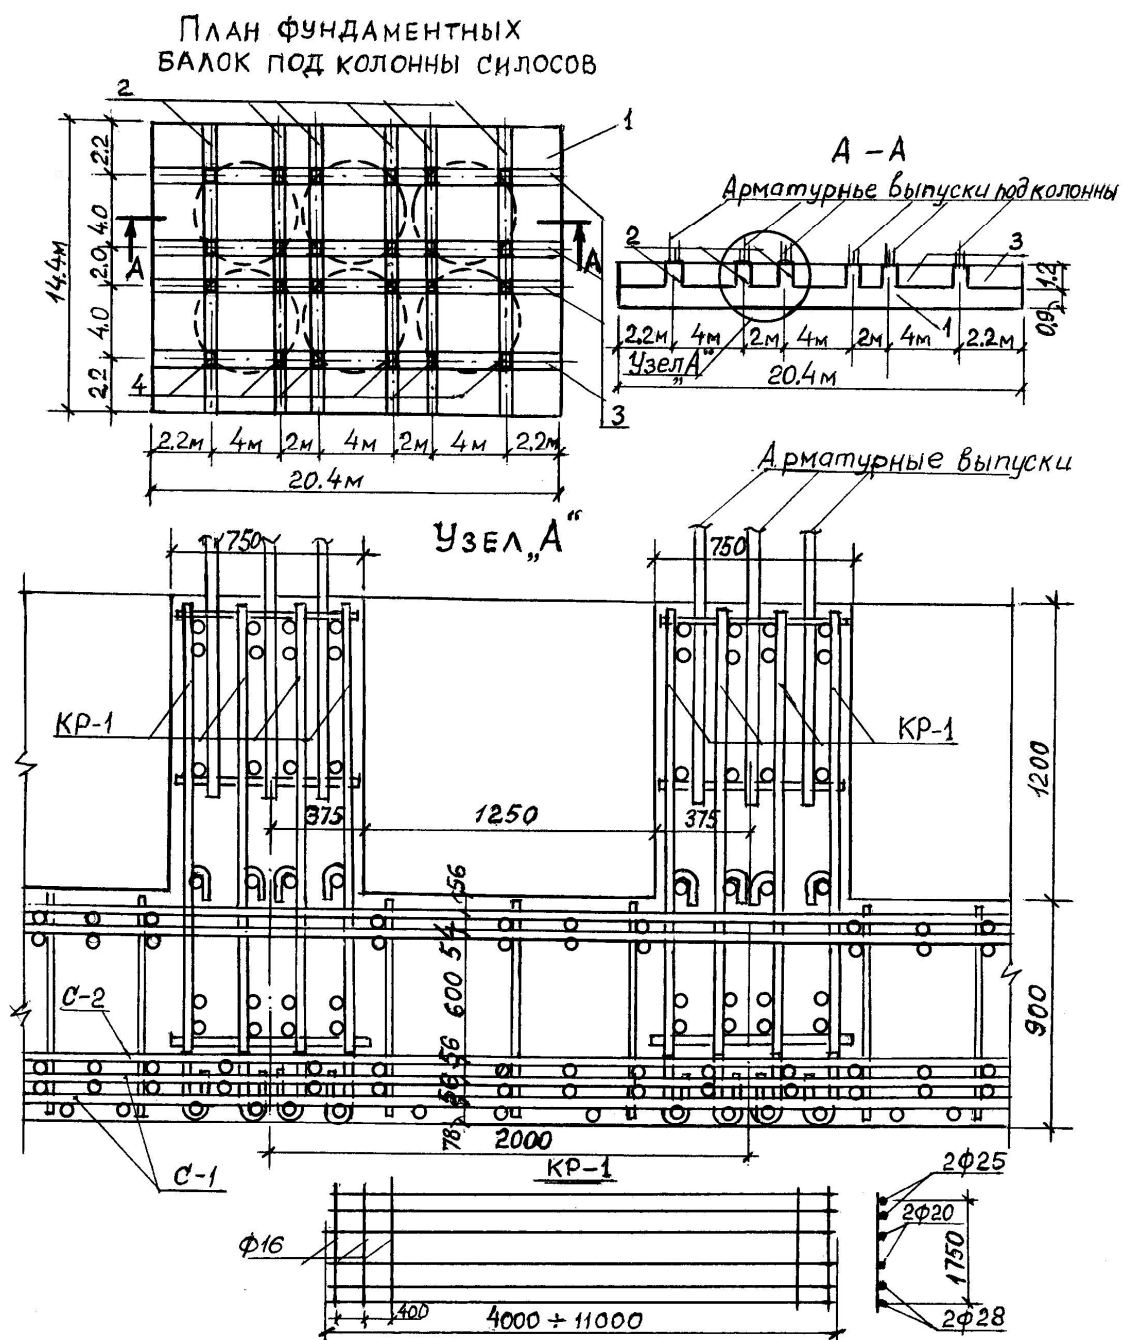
Вариант армирования фундамента под силосный корпус из 6 банок диаметром 6 м для хранения цемента: 1 – фундаментная плита; 2 – поперечные фундаментные балки; 3 – продольные фундаментные балки; 4 – pedestals колонн
